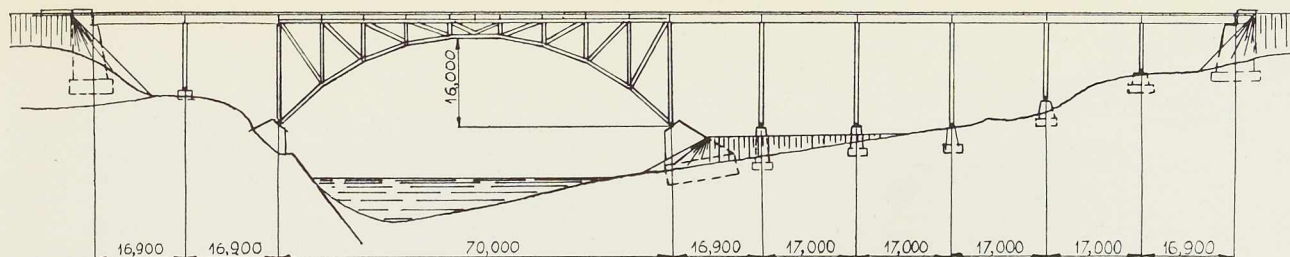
Elevation du pont-rails sur le Namsen (Norvège).
